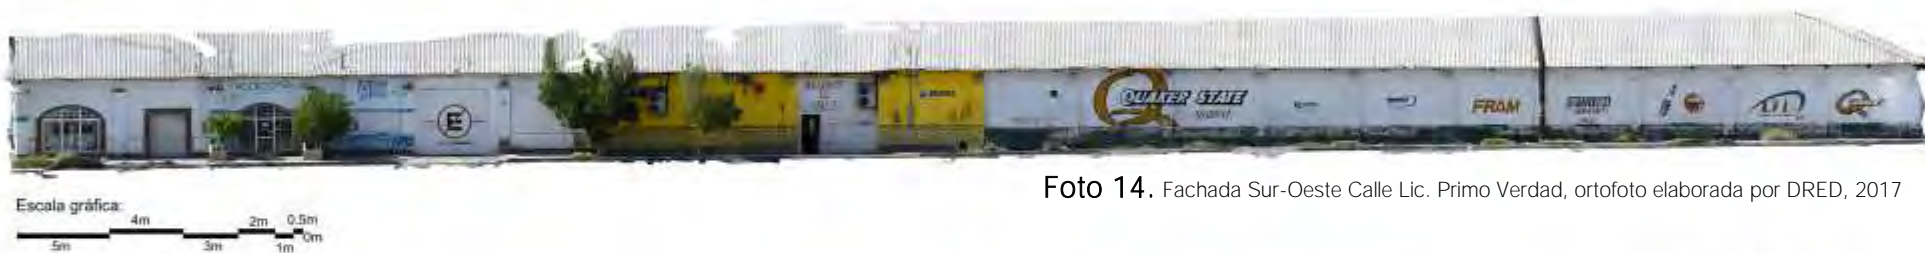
Fachada Sur-Oeste Calle Lic. Primo Verdad, ortofoto elaborada por DRED, 2017
